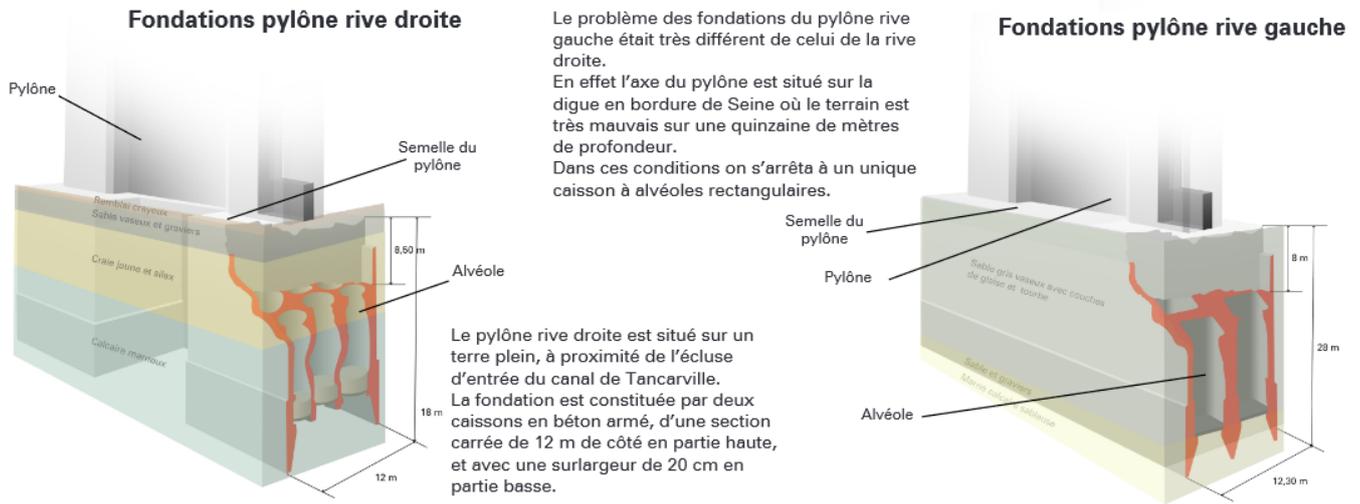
Fondations des pylônes rive droite et gauche du pont de Tancarville, source [5]
